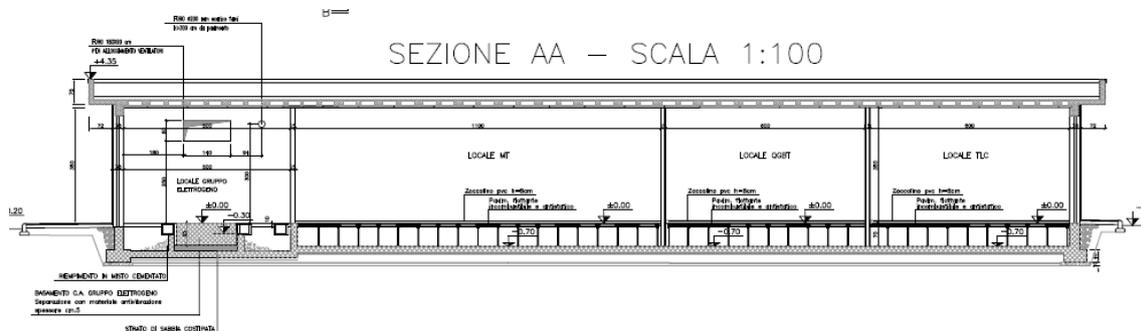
Sezione longitudinale dell'edificio – Versione PDAP
